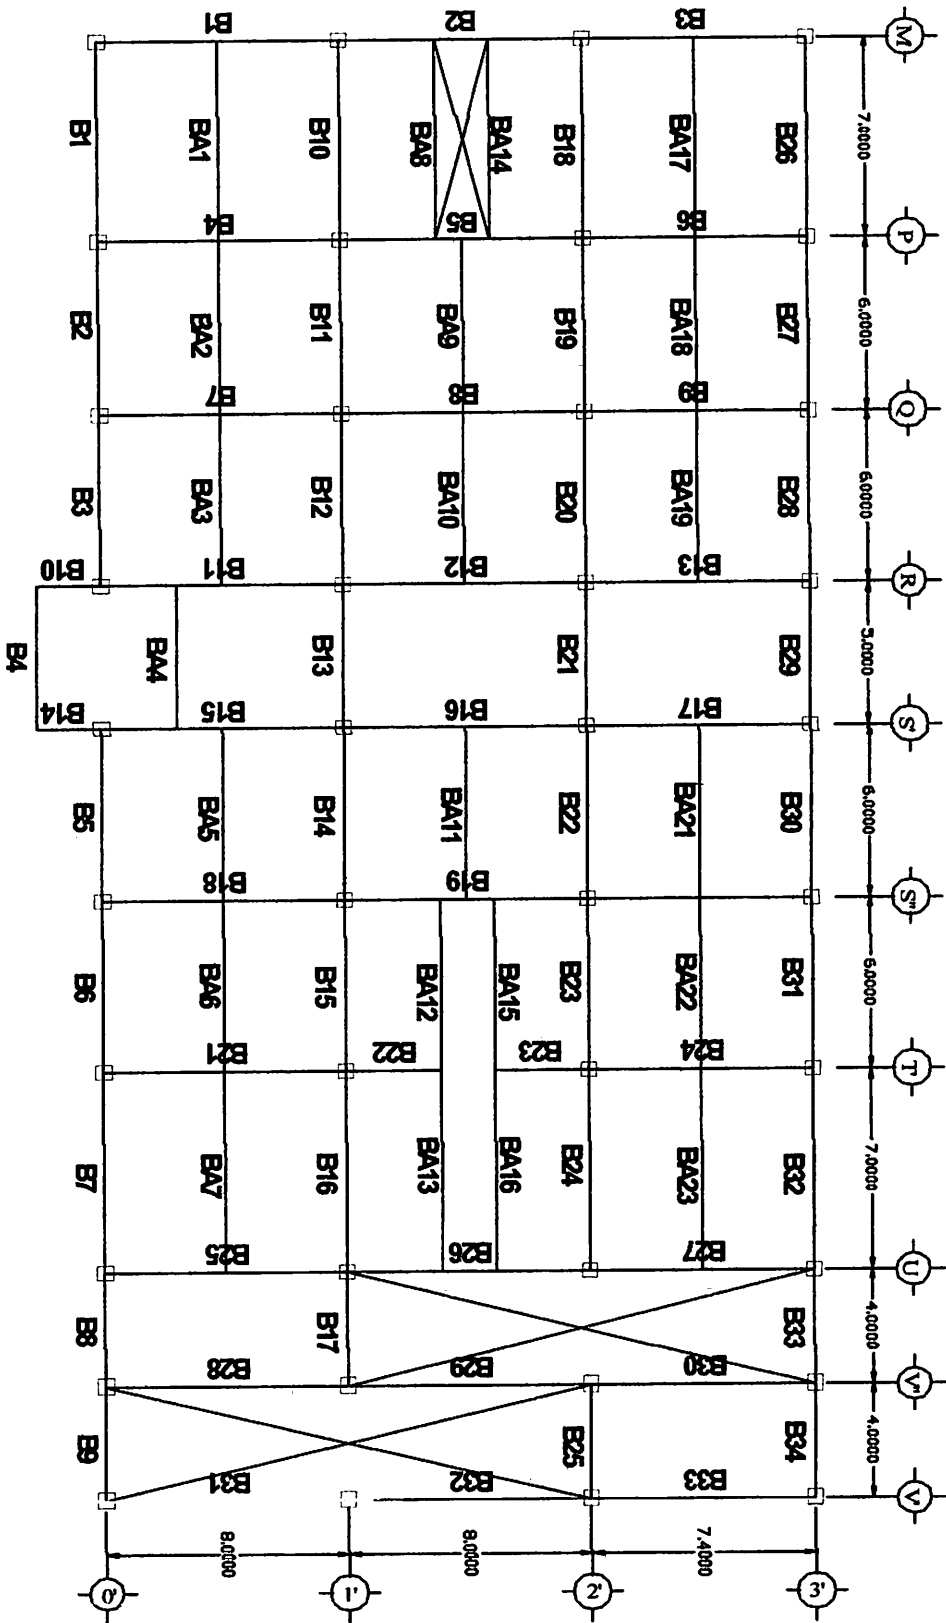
Denah Pelat Lantai 2 Pertokoan
